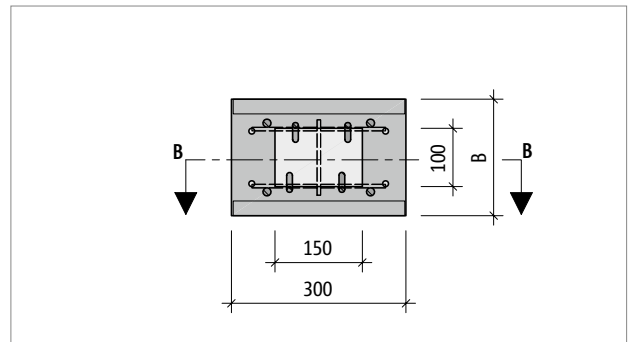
Schöck Sconnex® Typ W-NT1-V1H1: Produktgrundriss; Drucklagerfläche 150 × 100 mm
